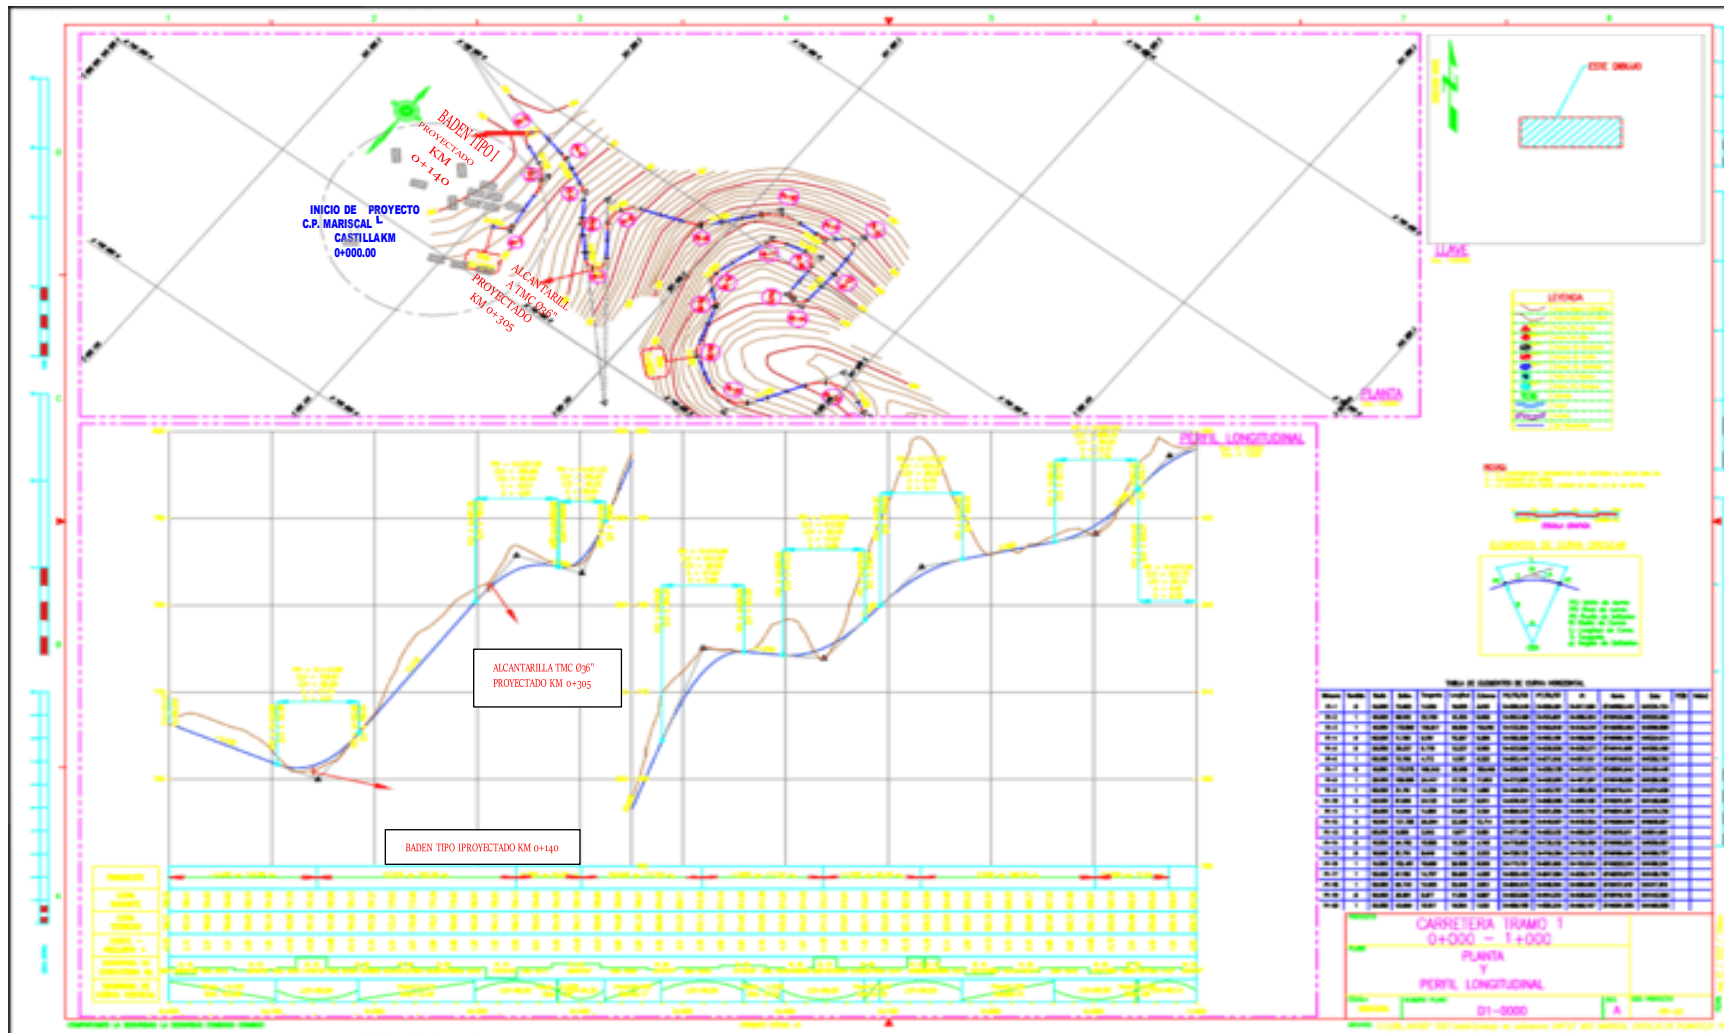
Carretera en planta y perfil longitudinal, tramo 1 (4+000 – 5+000).
